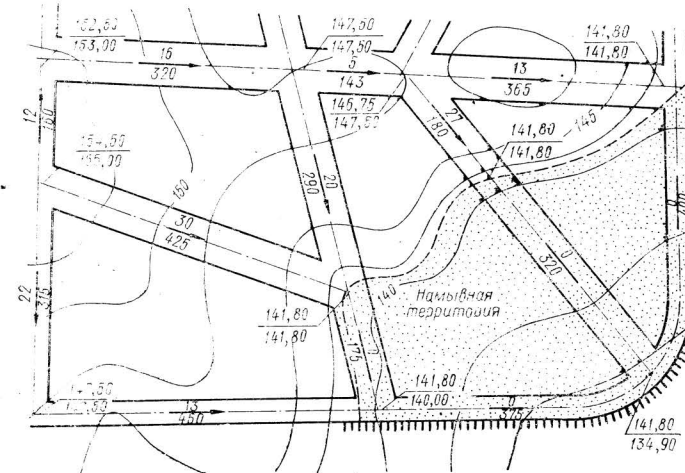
Схема вертикальной планировки города (фрагмент).
